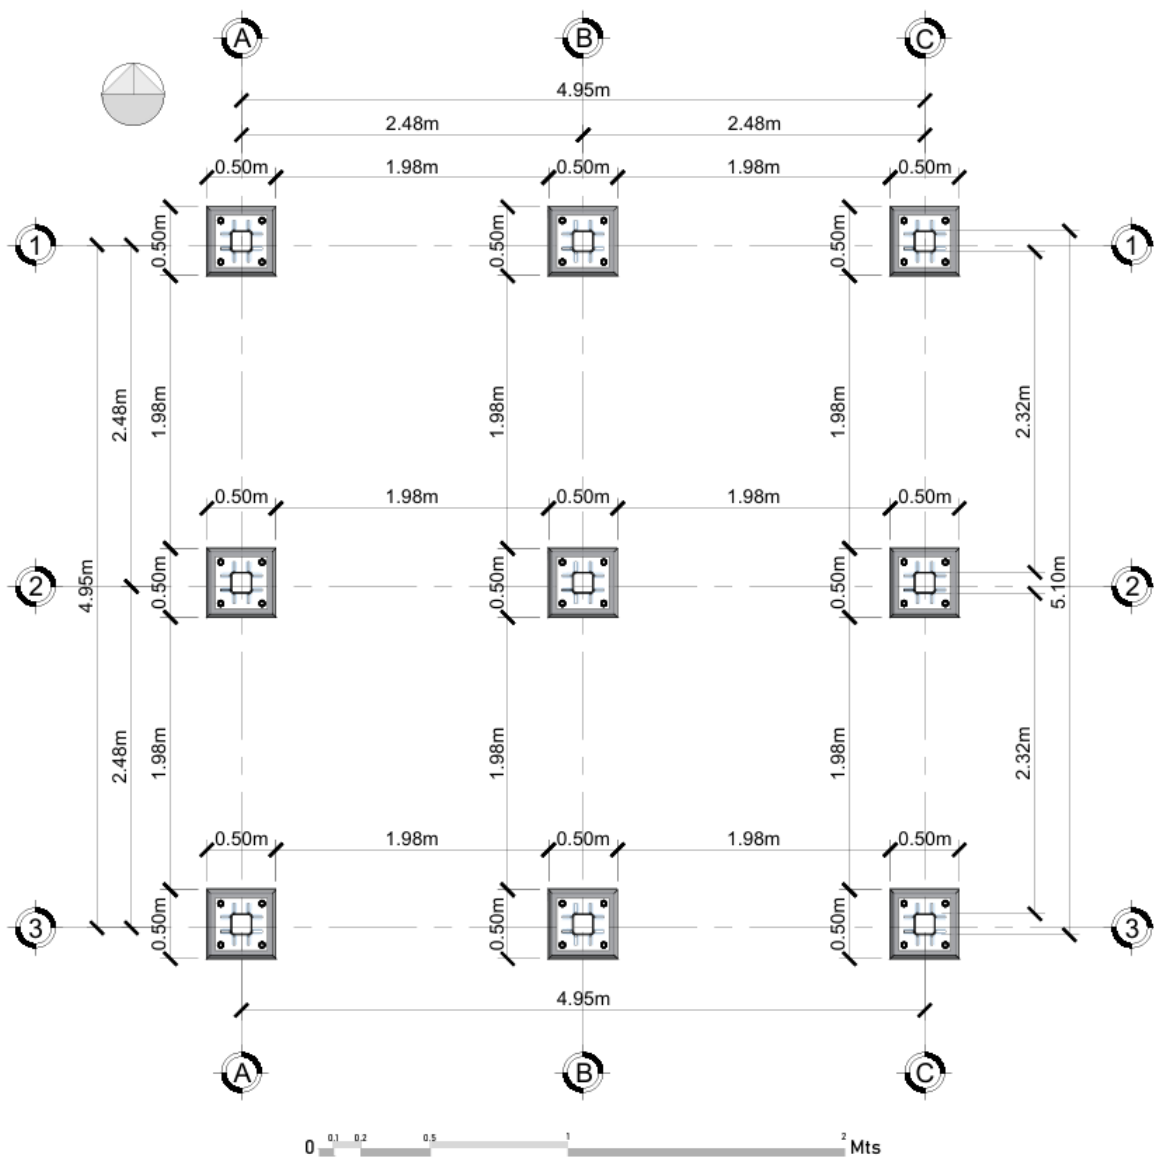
Planta de Cimentación. Fuente: Elaboración propia
